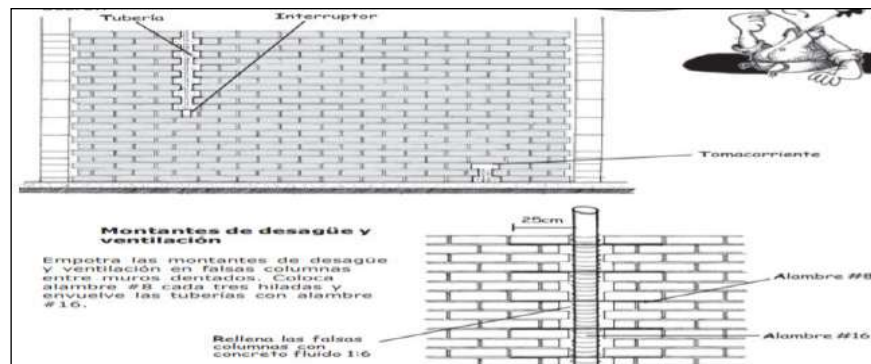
Construcción y mantenimiento de viviendas de albañilería.
